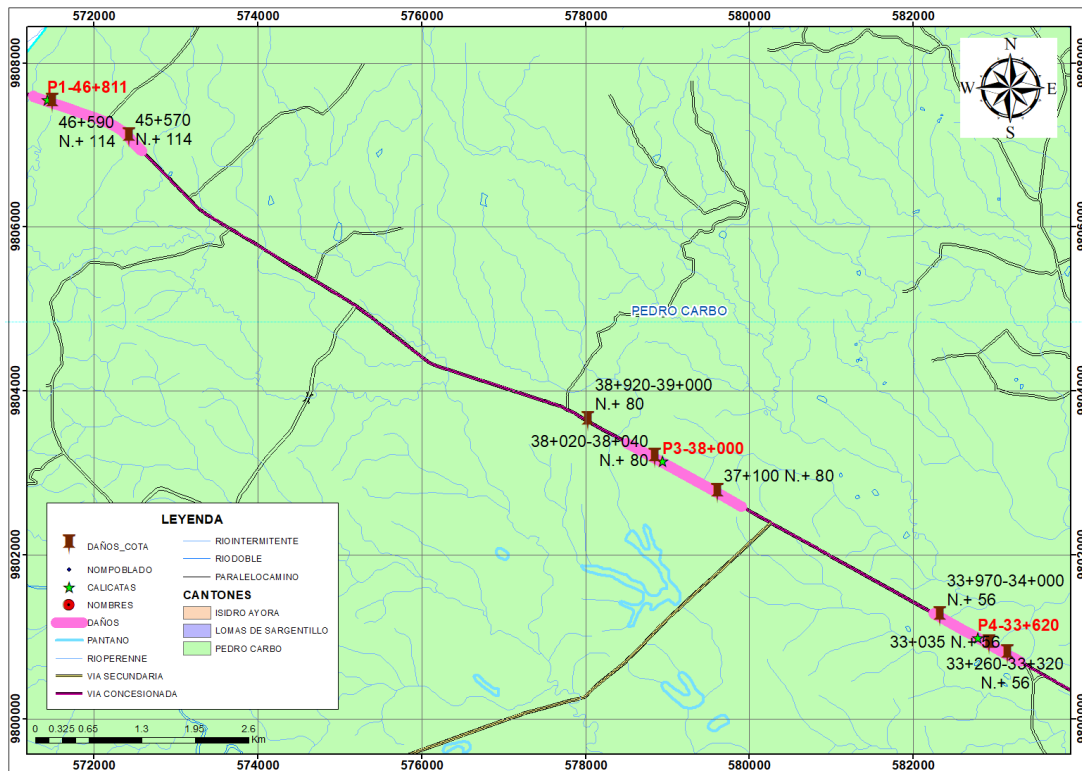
Esquema de Ubicación de Fisuras Existentes
